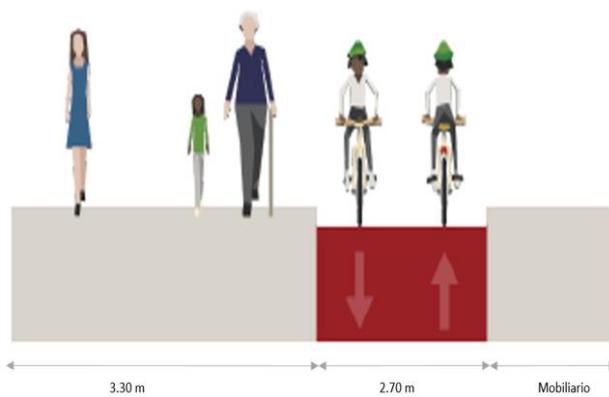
Sección tipo del tramo 1. Fuente Ayuntamiento Madrid - elaboración propia
